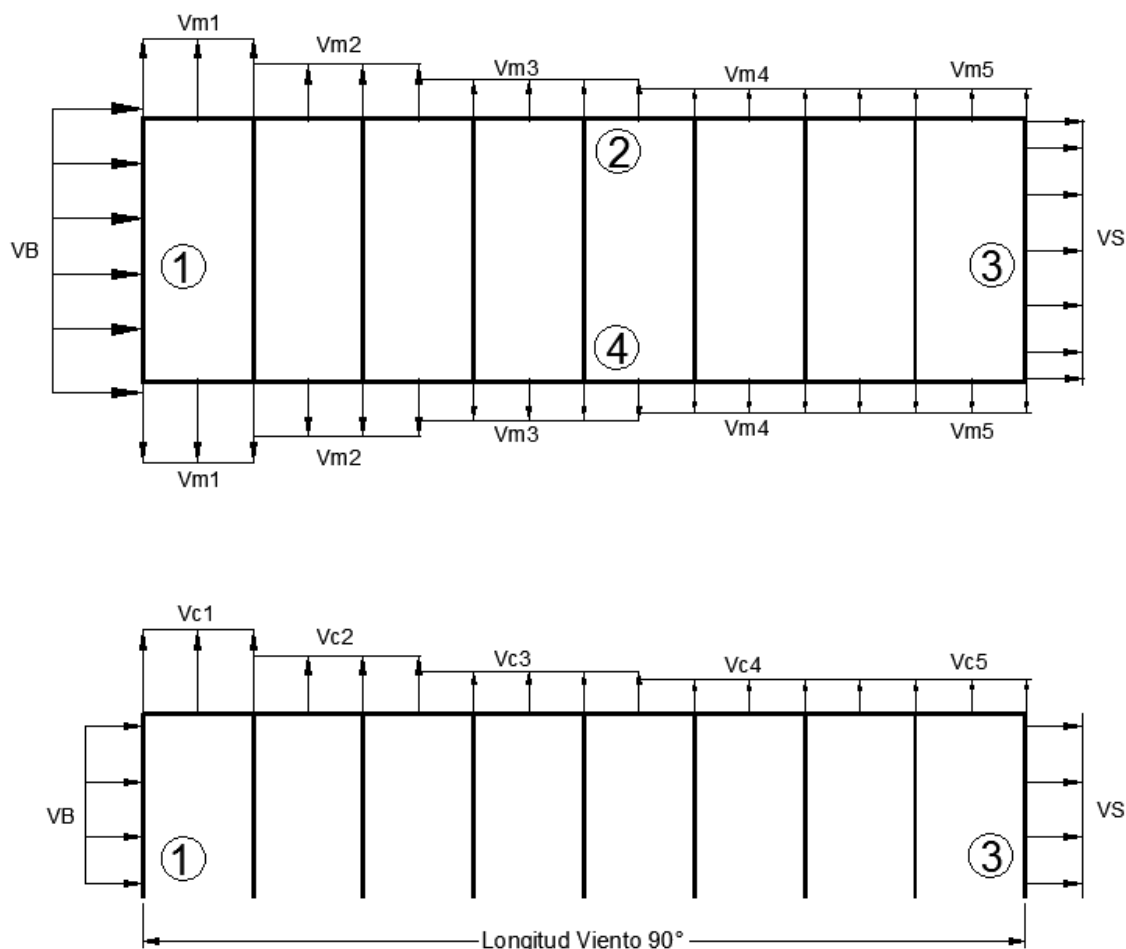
Planta y corte de distribución de presión en muros de viento a 90°.
